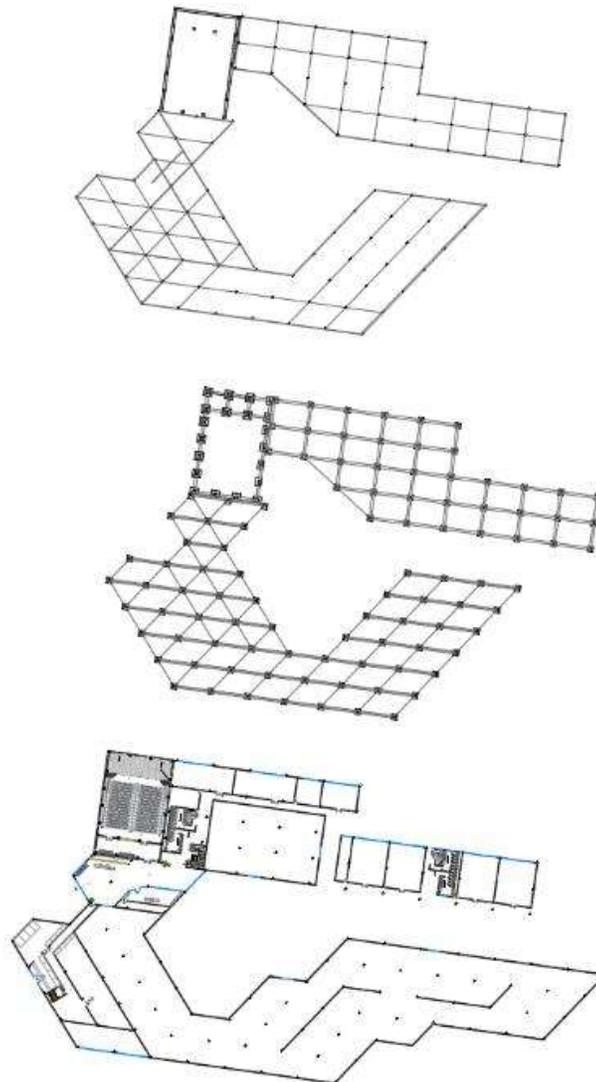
| Desarrollo del concepto, en la planta arquitectónica.
